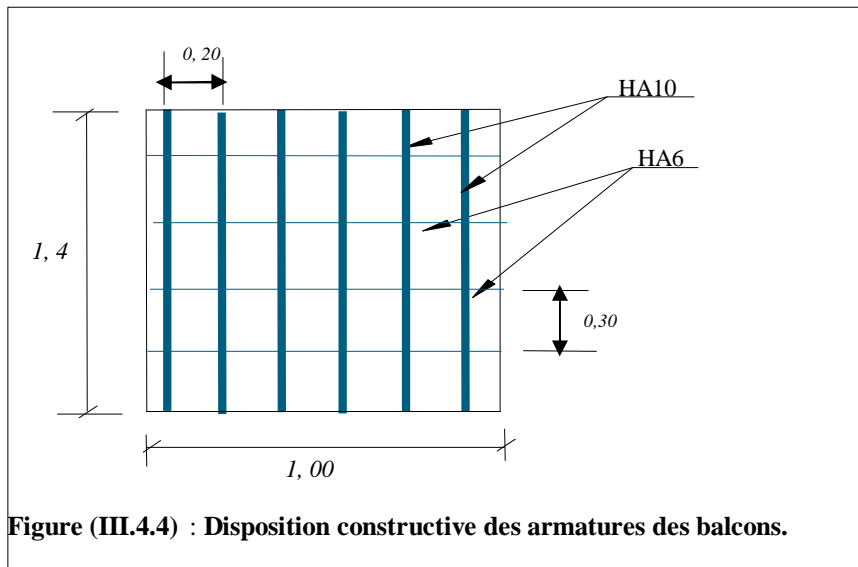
Disposition constructive des armatures des balcons.
